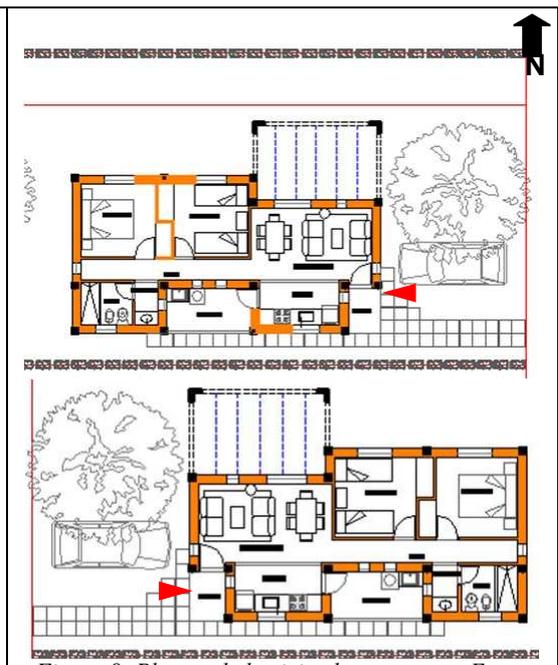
Plantas de la vivienda con acceso Este u Oeste
